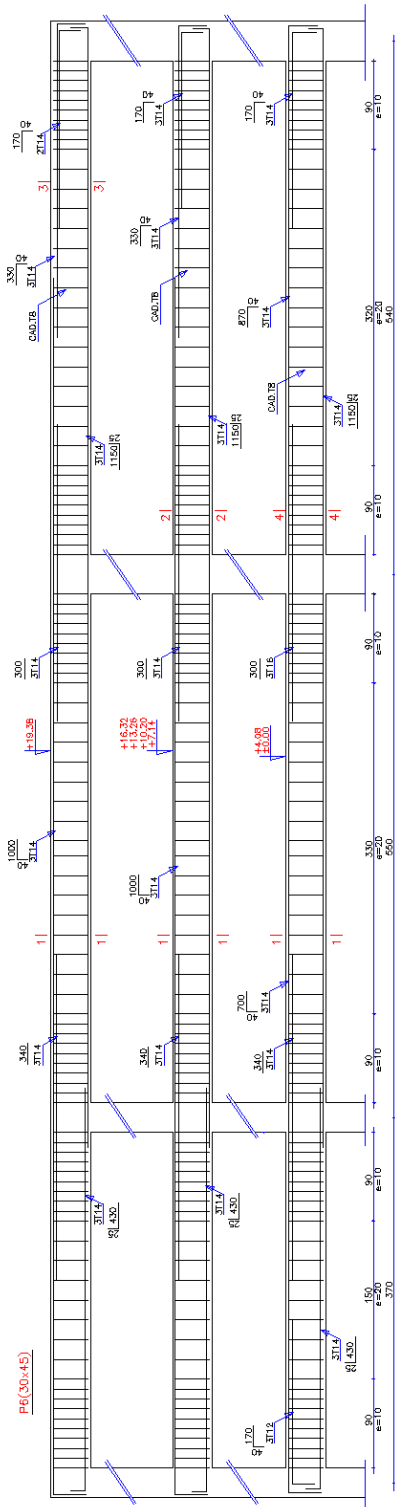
Ferrailage de la poutre principale (30x45) cm<sup>2</sup>
